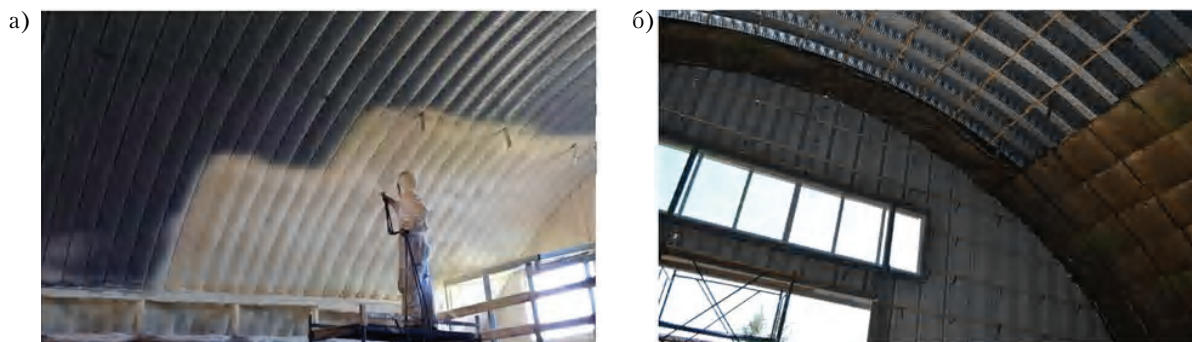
Варианты с внутренним утеплением сводчатого покрытия: а) утепление пенополиуретаном; б) утепление минераловатными плитами.
